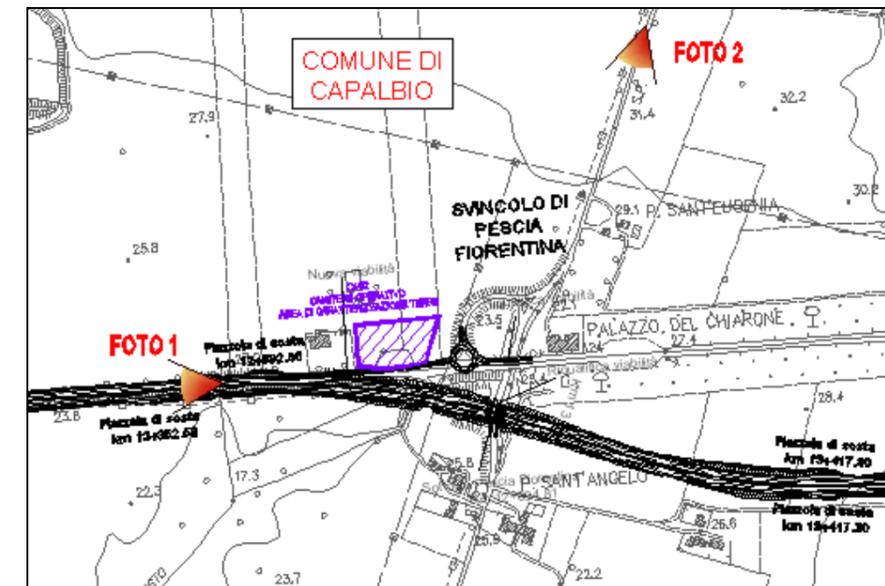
Stralcio planimetrico con individuazione dei punti di ripresa delle foto
